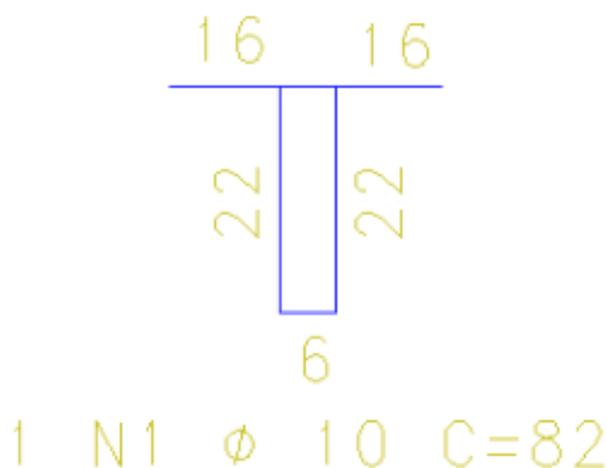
Detalhe de estribo salvo na pasta TQSW\SUPORTE\LAJES\BLOCOS
